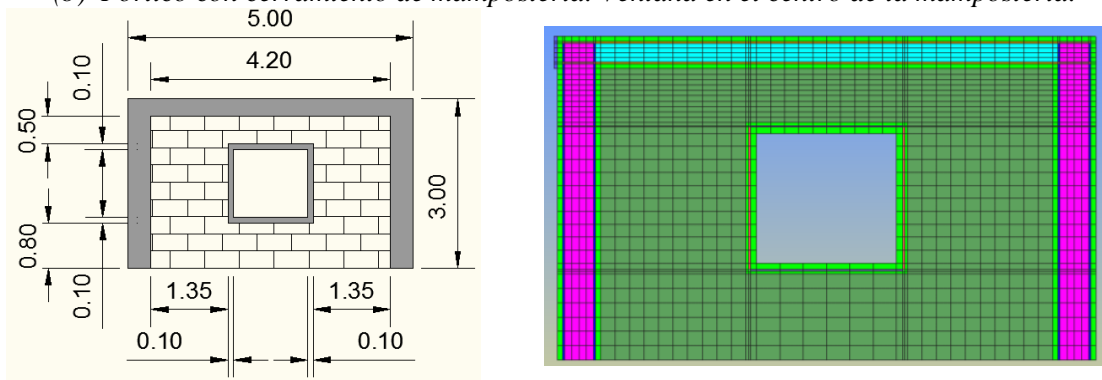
Mallas de elementos finitos para el pórtico de hormigón armado
